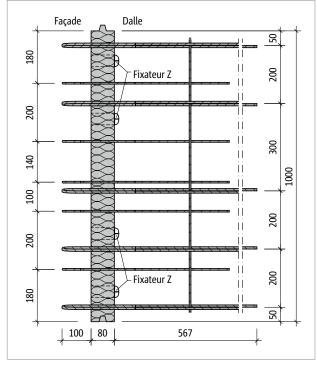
Schöck Rutherma® T type DFi-V4-LR100 : vue en plan du produit
